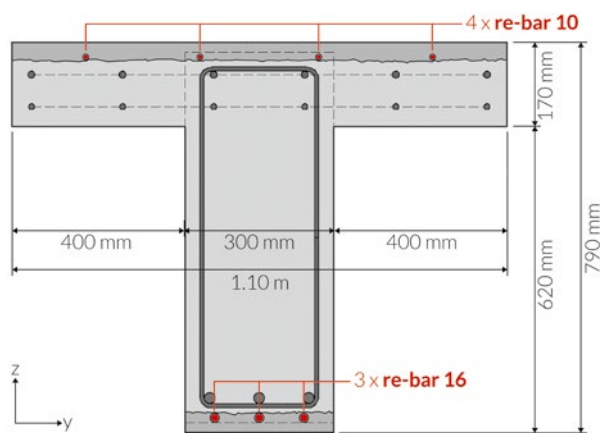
Nouvelle section transversale des poutres en T avec renforcement à la flexion au moyen de re-bar
